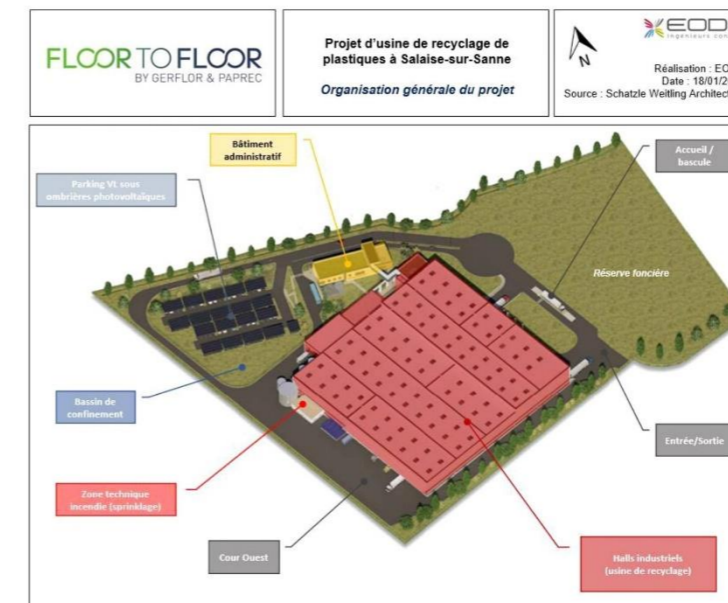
plan d'organisation générale du projet Floor to Floor (source : dossier)
